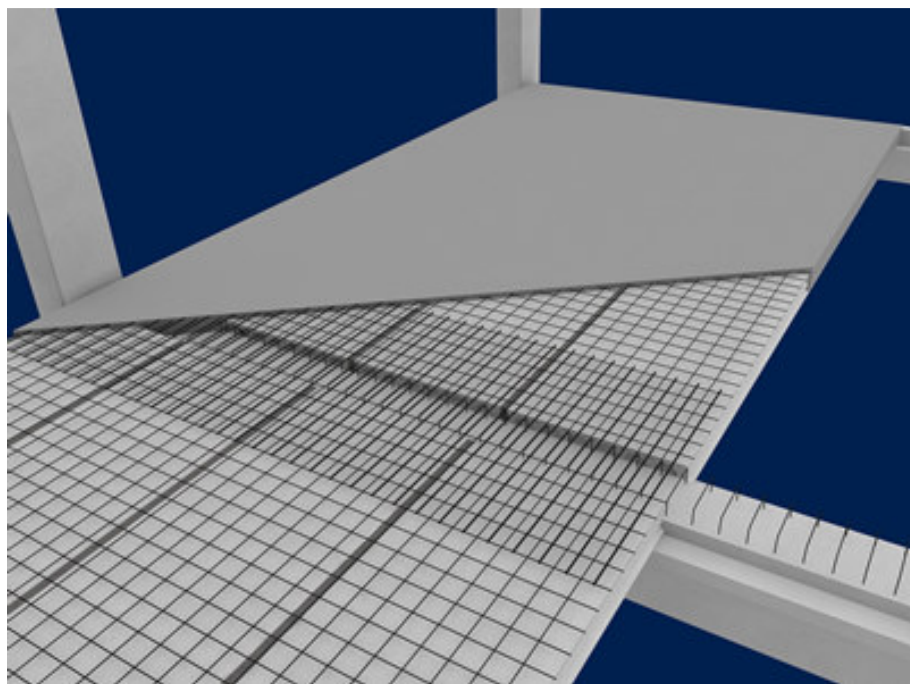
Lajes solidarizadas com capa estrutural de concreto
